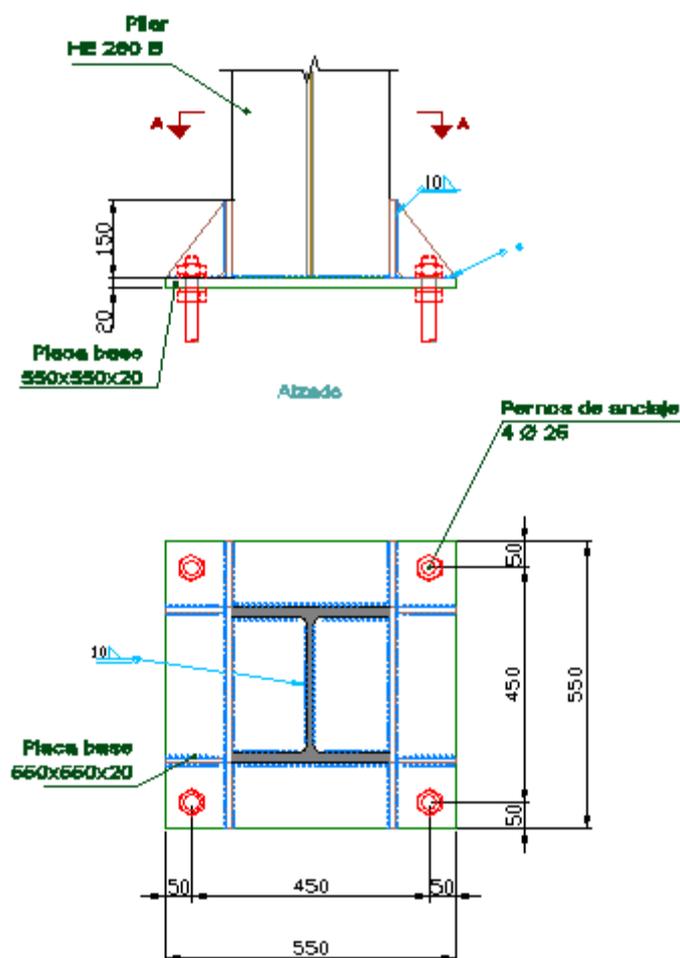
Placa de anclaje pilares hastiales y pilarillos
